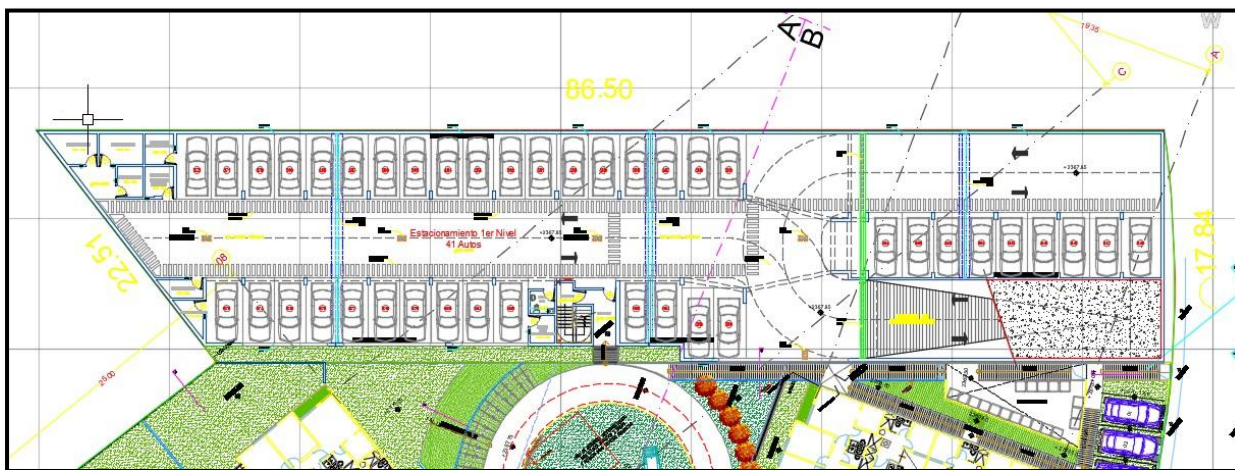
Planimetría ampliación Deck - Villa Verde 2 (Fuente: Gestión de alcance-Planos (4))
